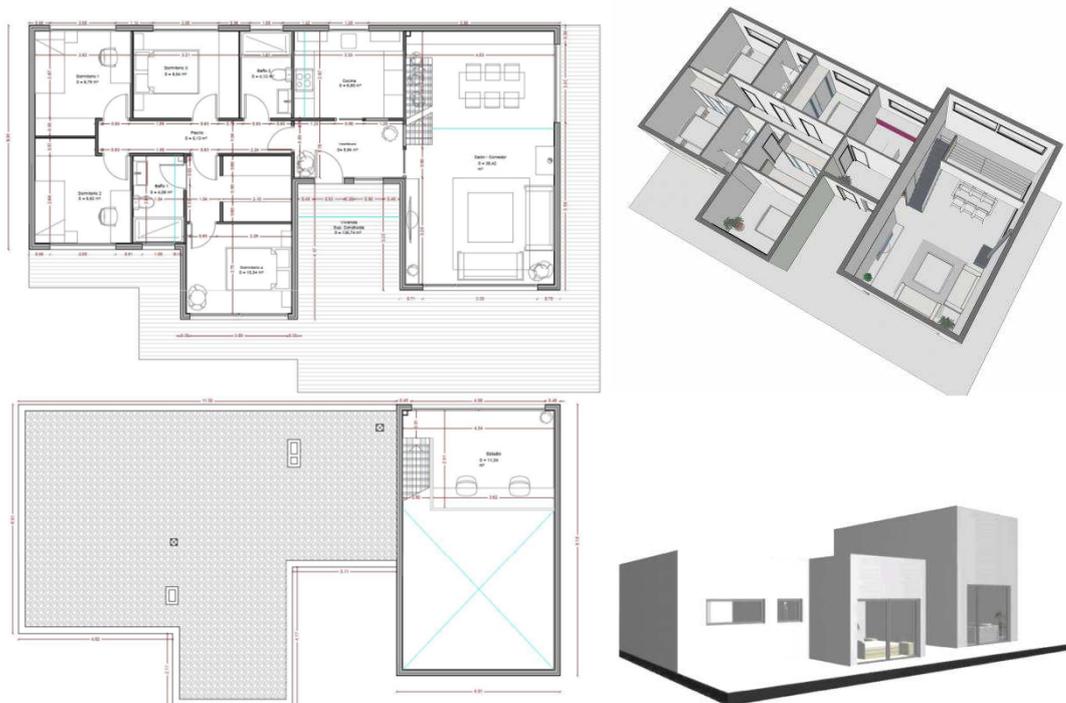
“Caso de estudio: planta baja, entreplanta y perspectivas”. Fuente: estudio Heliopausa
